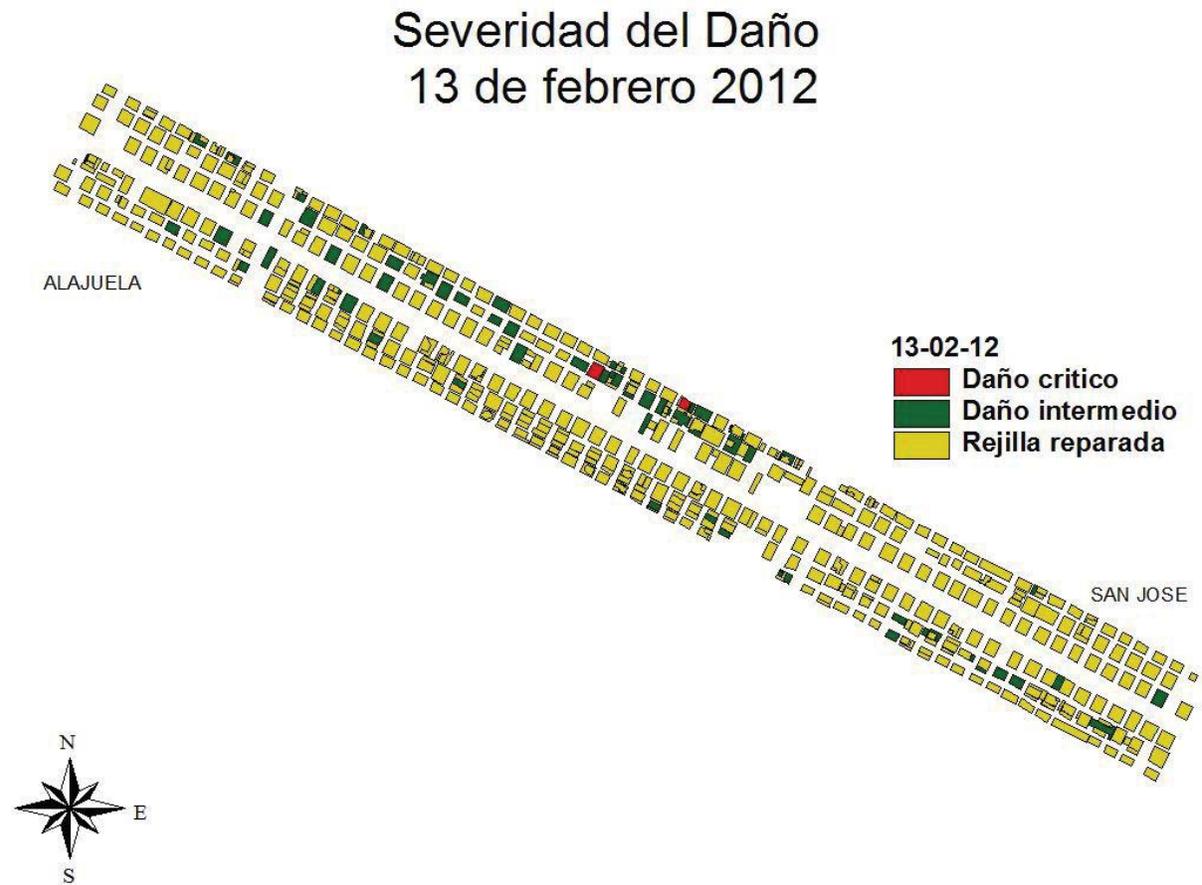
Ubicación de las zonas deterioradas en la losa sobre el puente
